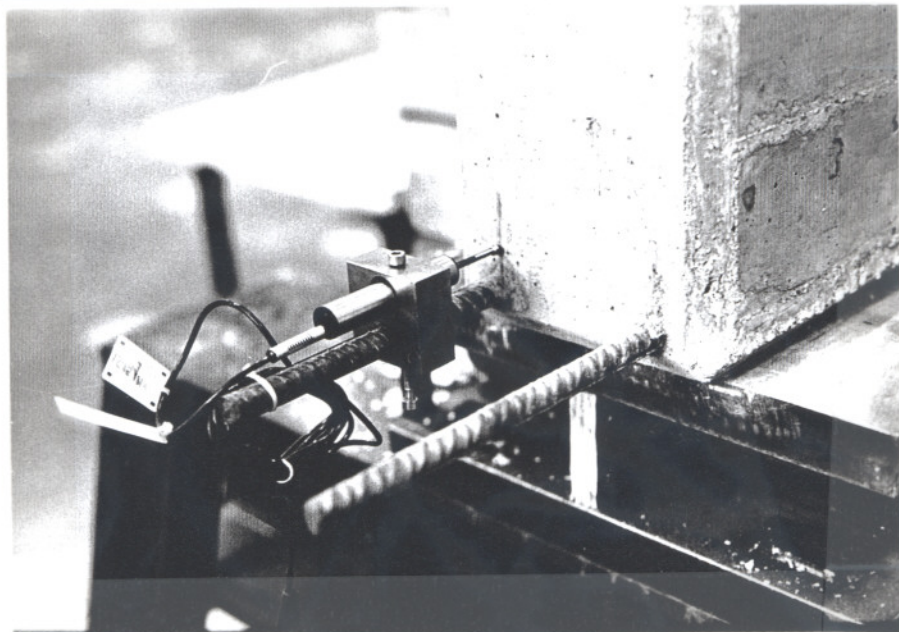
Con el fin de detectar el posible deslizamiento de la armadura traccionada, en las vigas de la 2ª serie, ensayadas a rotura inmediatamente después del descimbrado, se colocó un LVDT sujeto al tramo exterior de la barra, midiendo así la distancia entre el punto de sujeción y la cara extrema de la viga.
